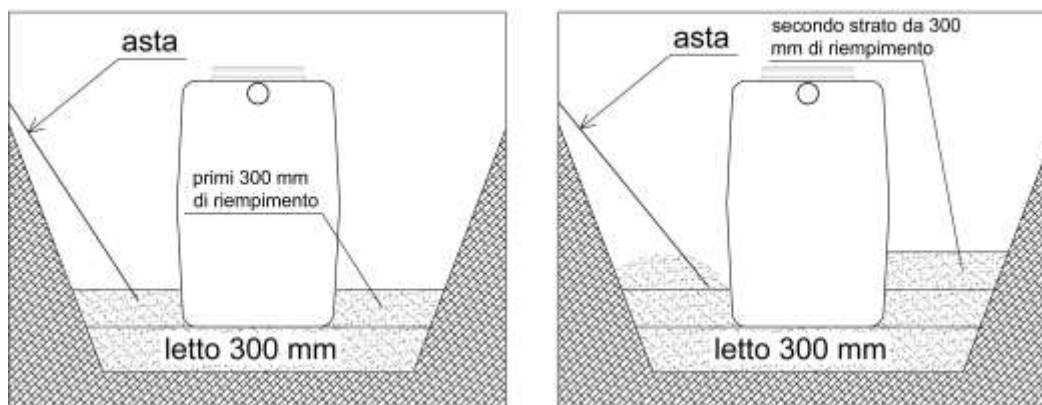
RIEMPIMENTO CAVO DI POSA
